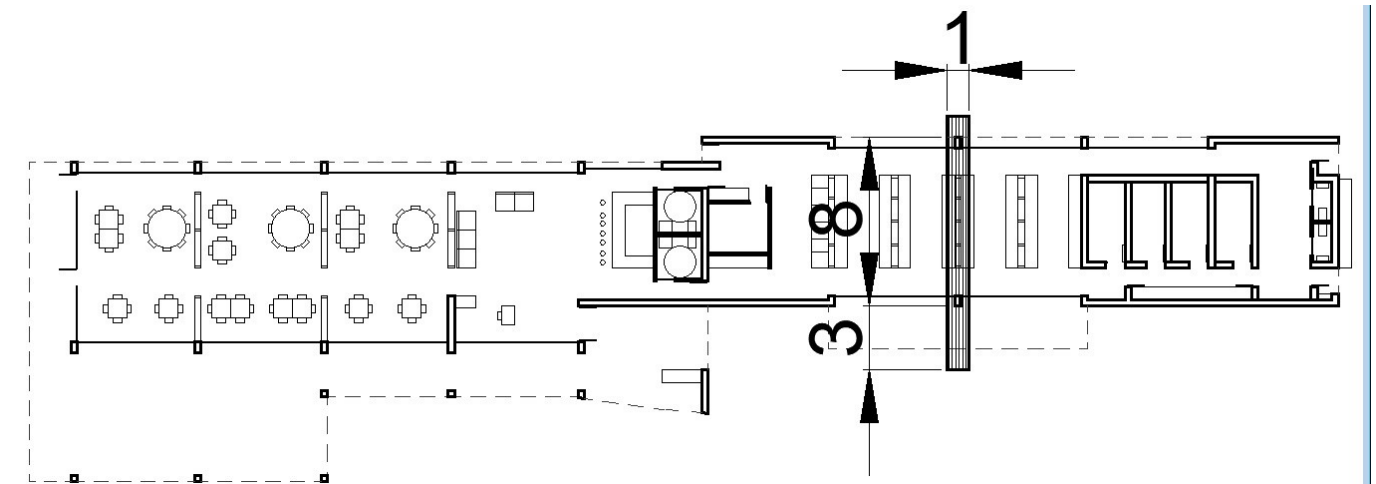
Sección característica. La losa de cubierta se modeliza como una viga de ancho unitario
